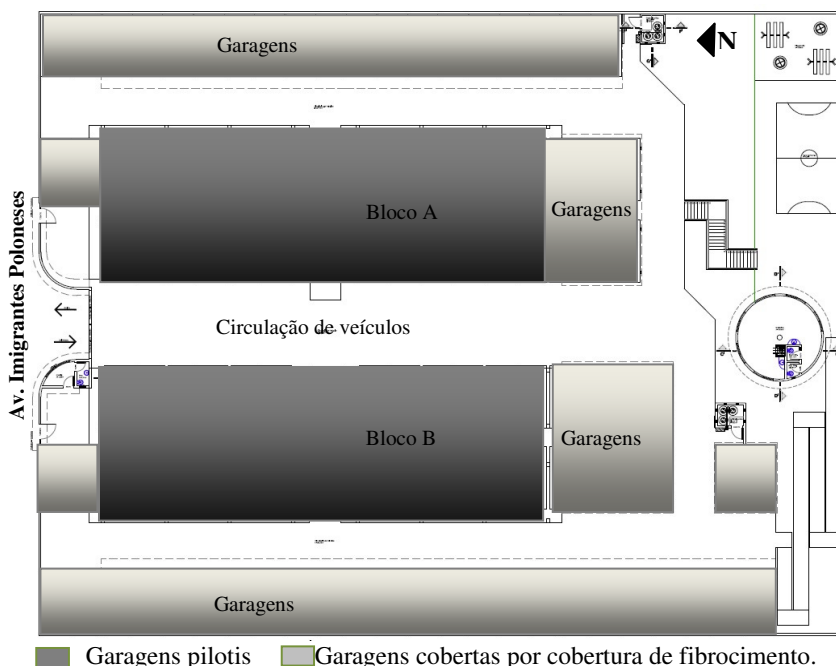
Planta baixa pavimento térreo com pilotis e garagens cobertas. Fonte: Construtora A adaptado pela autora.
